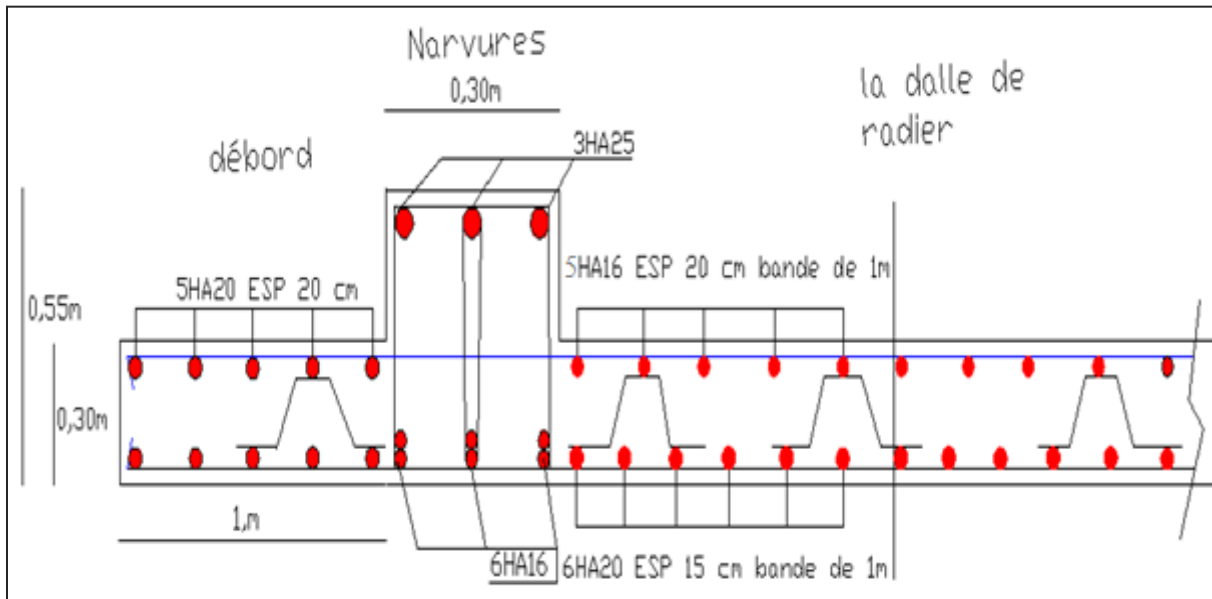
Ferrailage du radier générale sens Y-Y coupe en appui
